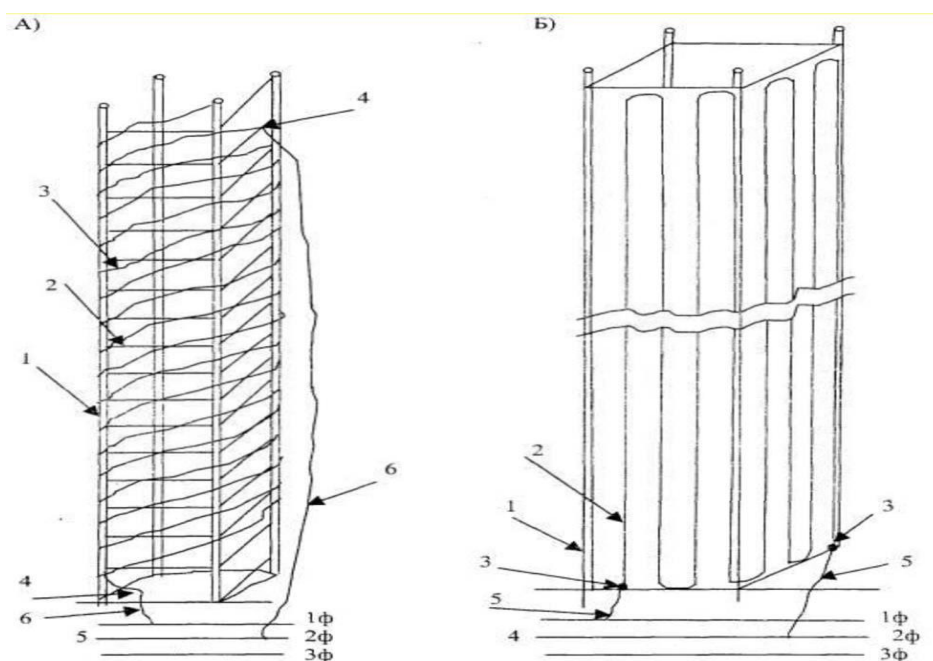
Установка греющего провода при прогреве колонн 40x40 см
